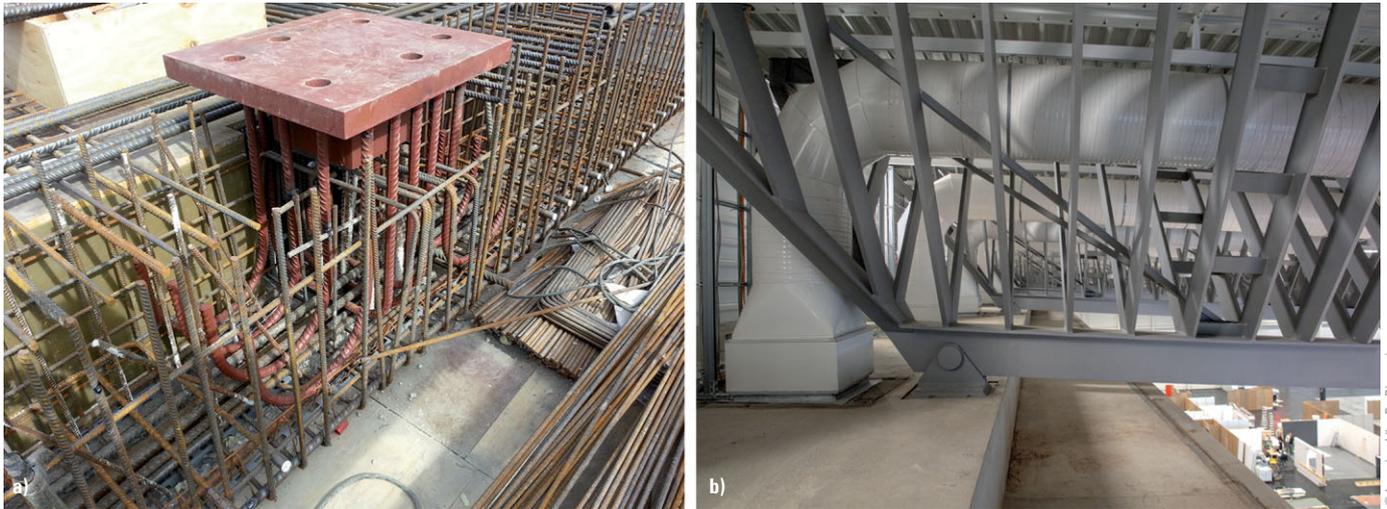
a) Bewehrung des balkenartigen Versprungs der Dachdecke mit Einbauteil der Dachauflager; b) Fertiggestellter Auflagerpunkt des Dachbinders inkl. Lüftungsrohr und Deckendurchführung
